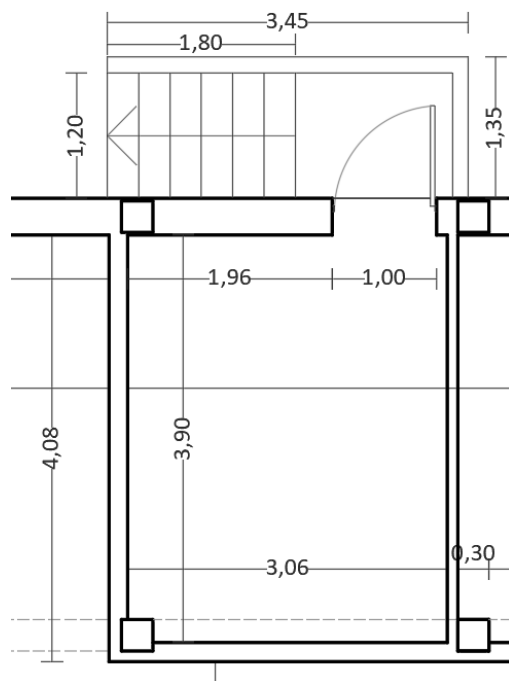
Planta acotada do cuarto de instalacións do edificio reformado. Elaboración propia.
